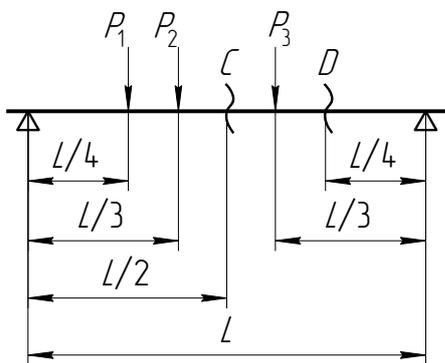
Расчетная схема балки с подвижной нагрузкой
